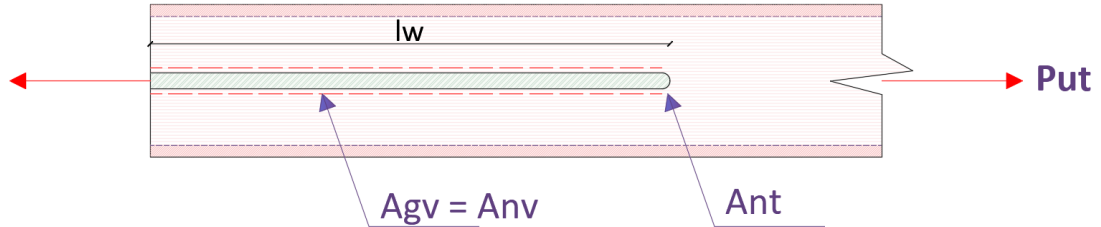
Detalle de soldadura en arriostre superior.
